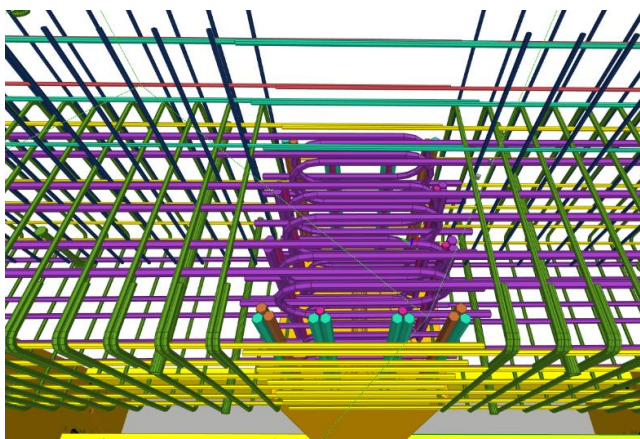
Vista del modelo en el encuentro de los pilares prefabricados con los dinteles prefabricados
